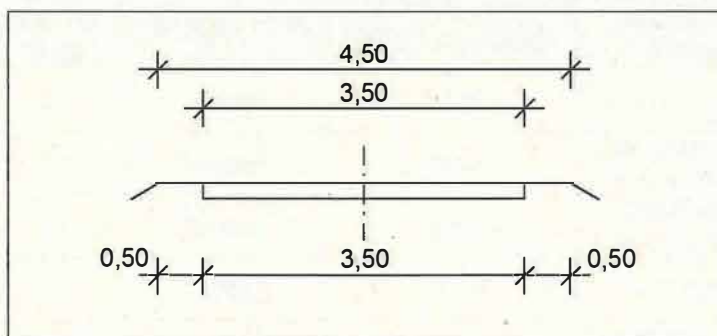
Straßenquerschnitt Zufahrt zum RRB 2
